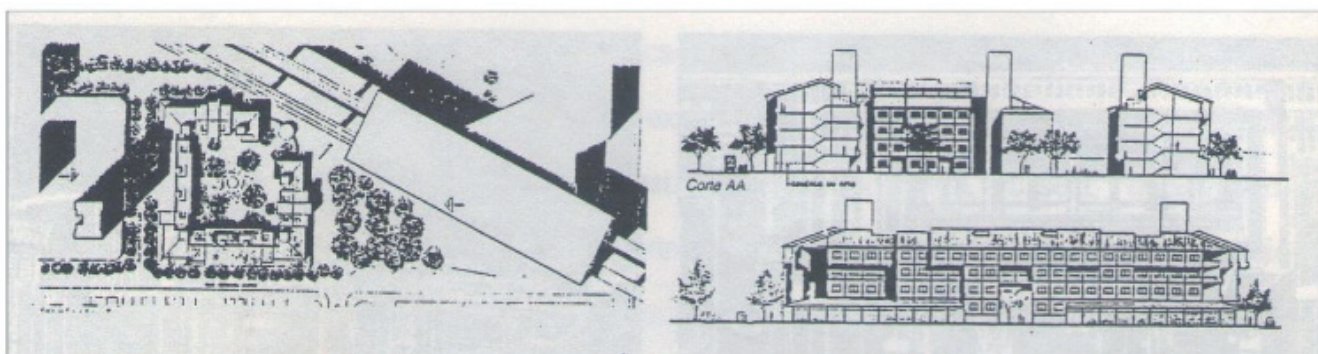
Implantação, Corte e Elevação do Conjunto – Arq. Aflalo e Gasperini
